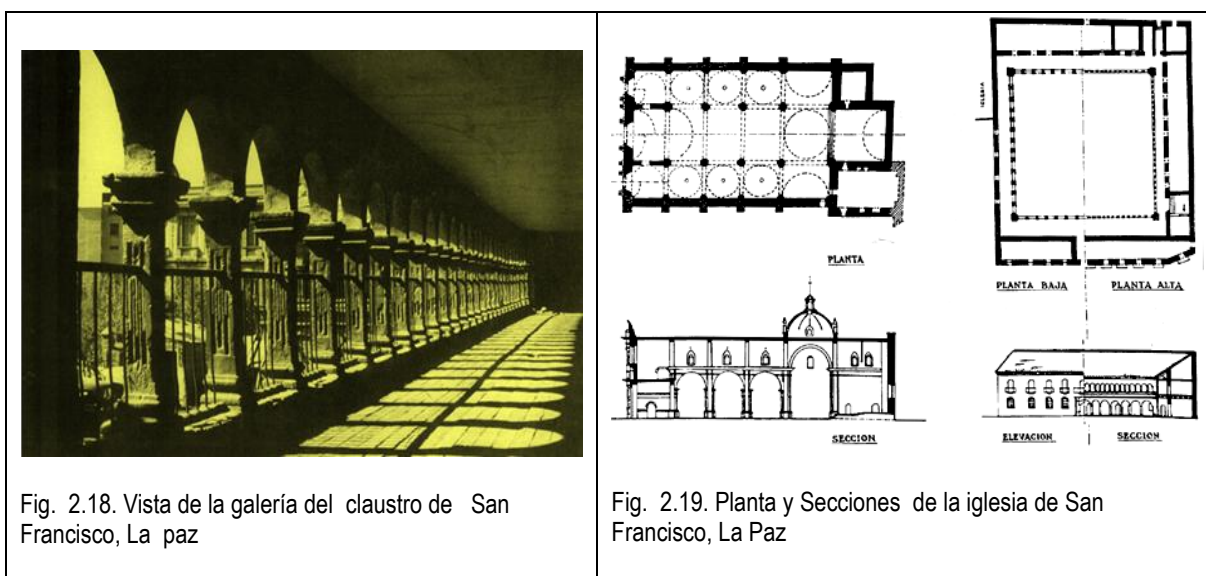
Vista de la galería del claustro de San Francisco, La paz
